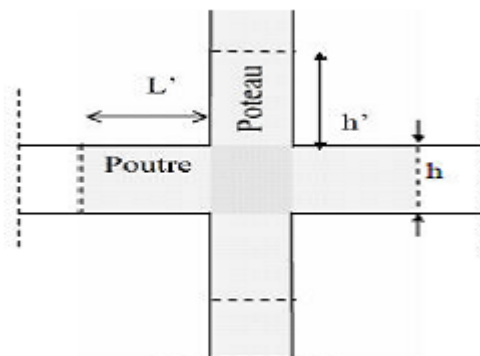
schéma explicative des zones entre poteaux-poutres.
